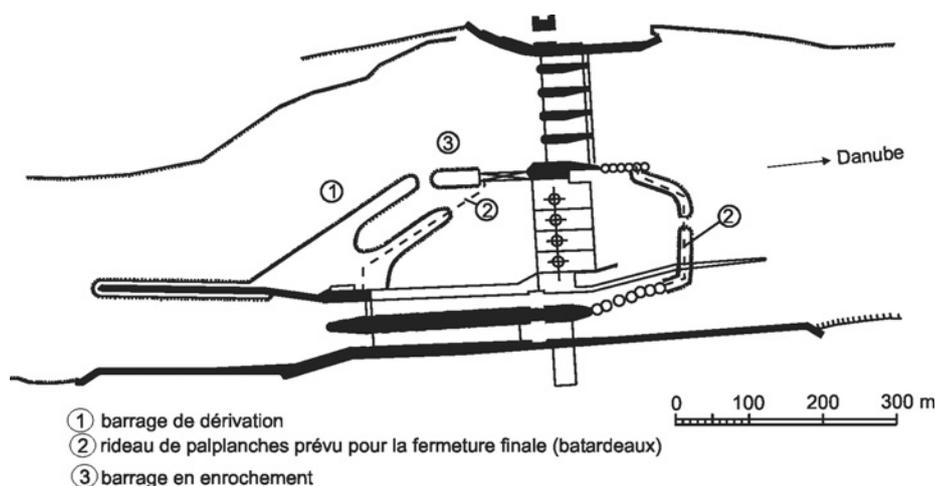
Dérivation d'une rivière pour la phase finale de construction de la centrale hydroélectrique d'Aschach, sur le Danube (Autriche)
